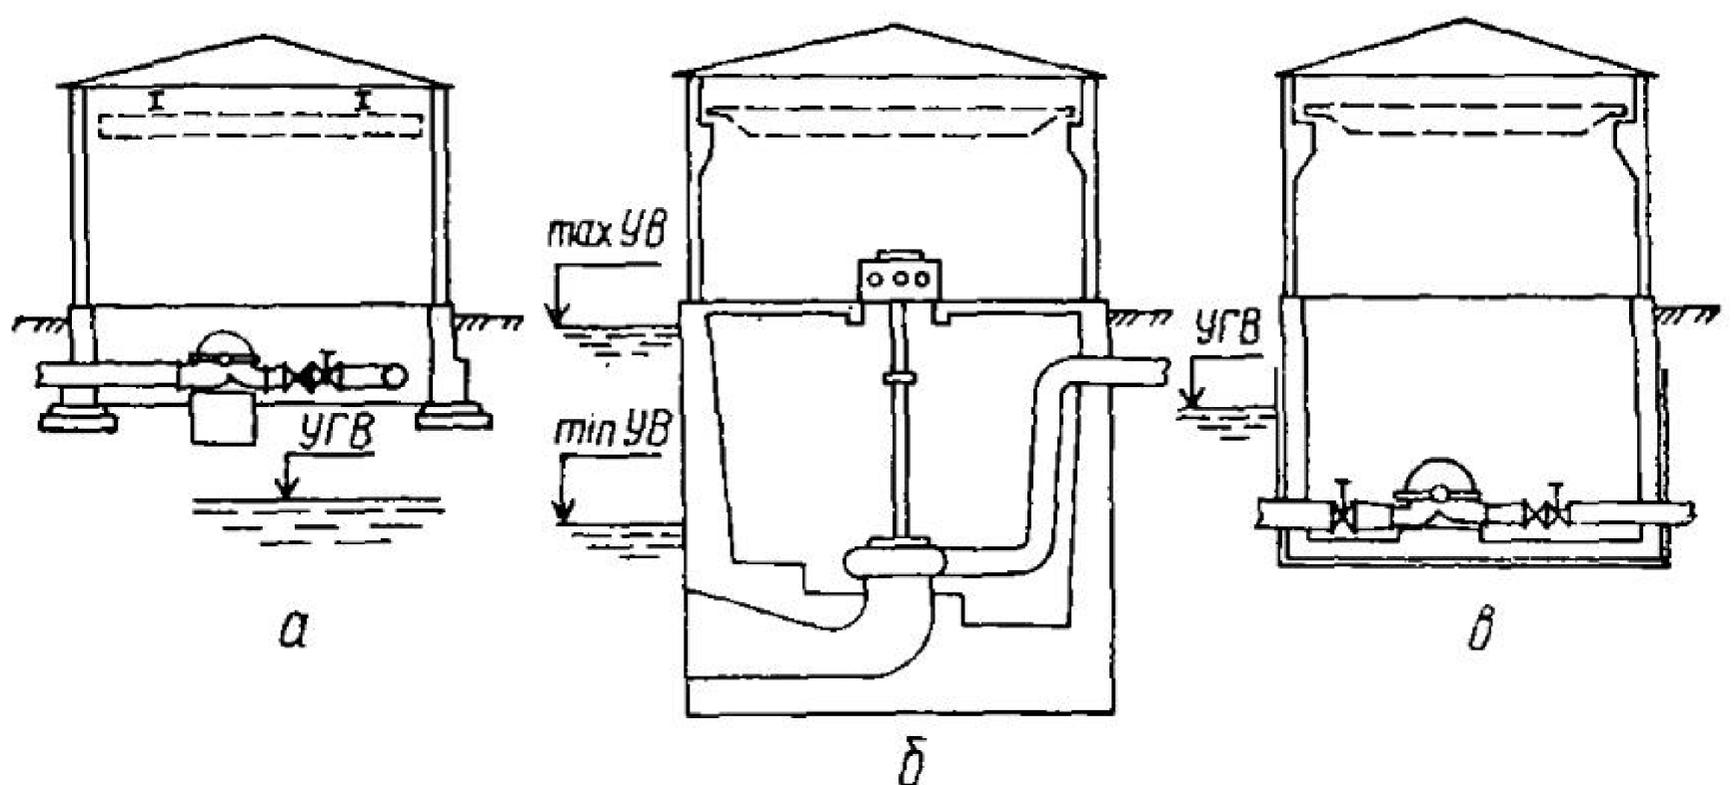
Типы конструкций подземной части насосных станций: а — с отдельными фундаментами под оборудование и строительные конструкции; б — блочная; в — камерная
